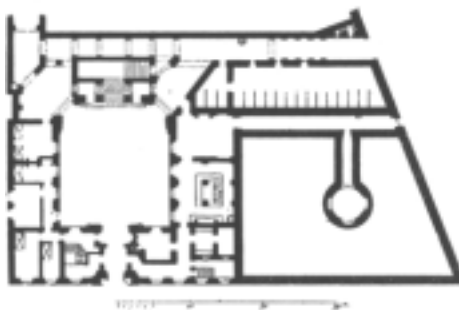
Ancien hôtel Lambert, à Paris. Plan du rez-de-chaussée.
